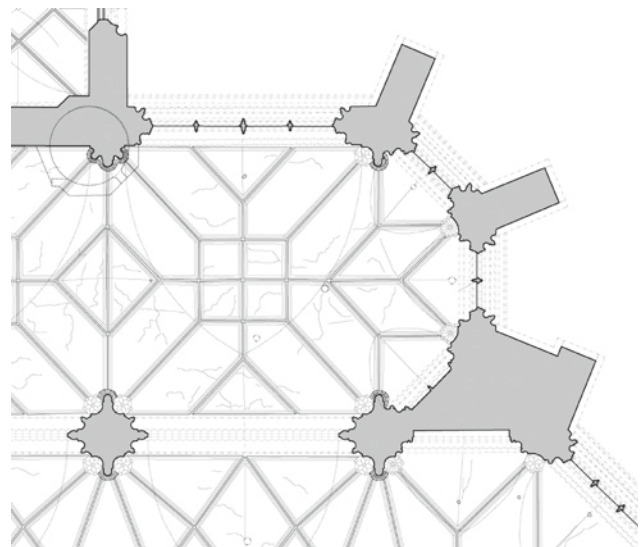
Stadtpfarrkirche Steyr, Ausschnitt Emporengrundriss mit Gewölbeuntersicht
